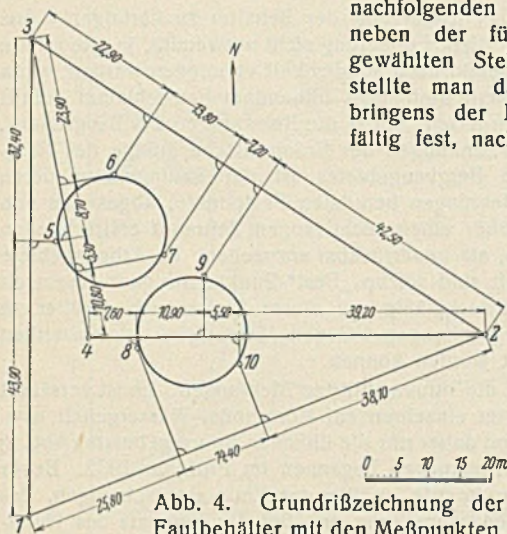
Grundrißzeichnung der Faulbehälter mit den Meßpunkten.
